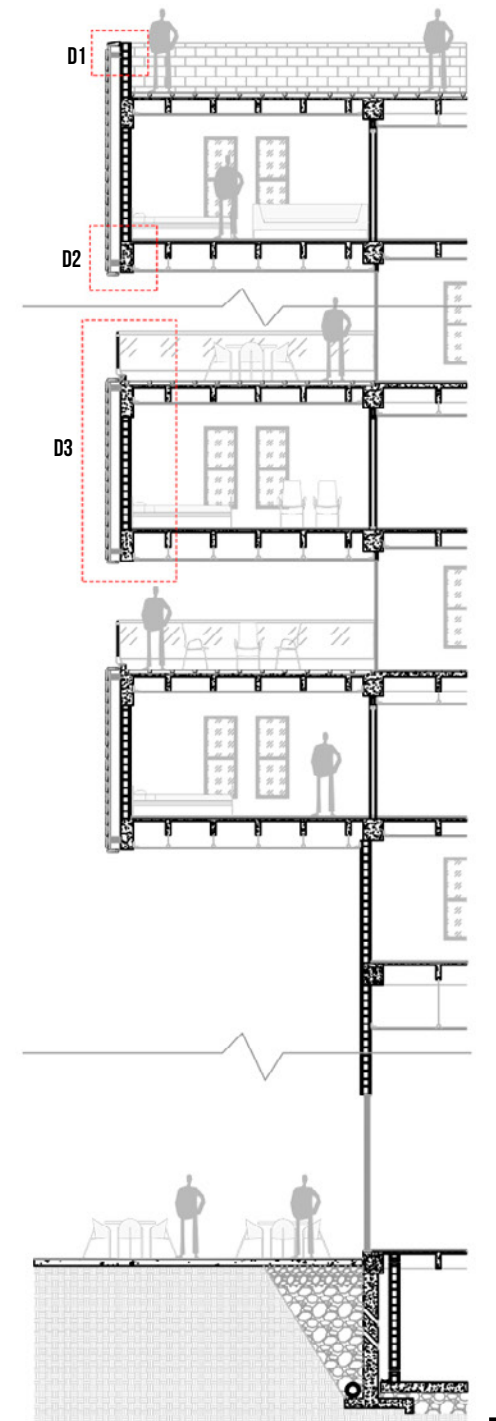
Planimetría complementaria. Detalles, Corte por fachada y fachada.
